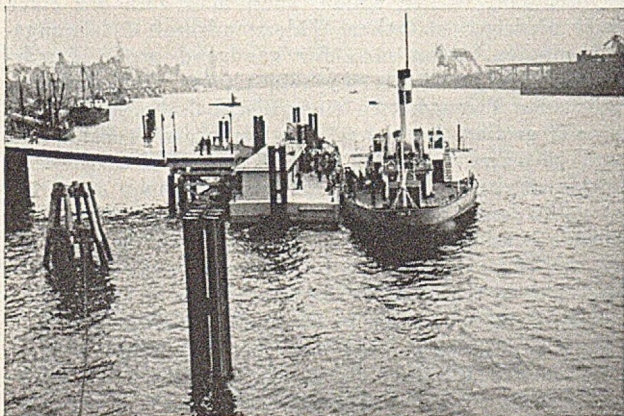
Mit Stahldalben ausgerüstete Fährpontonanlage in Hamburg-Altona.
